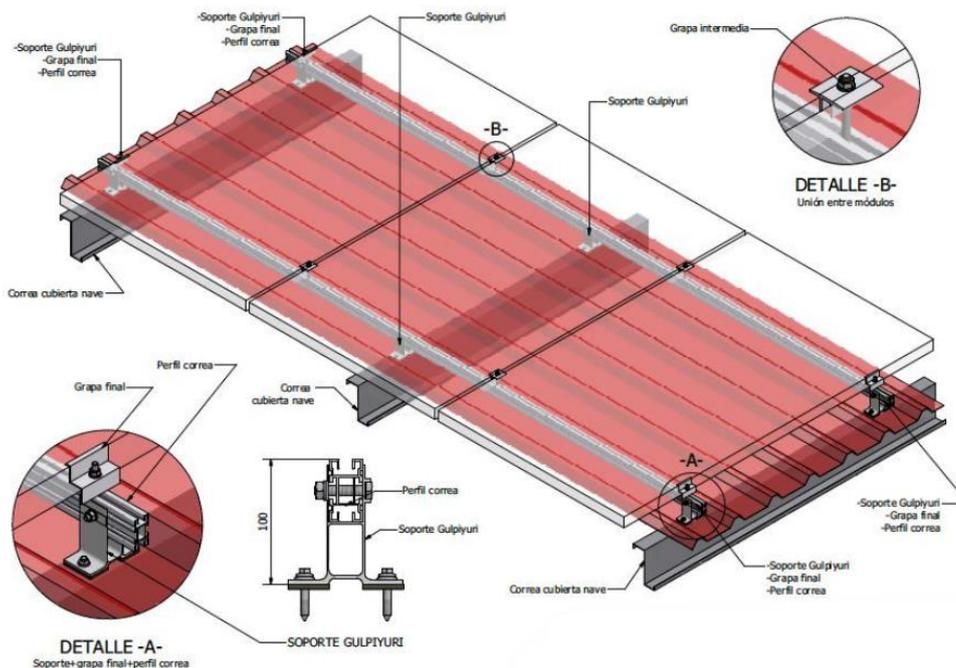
Soporte fijo de placa en cubierta inclinada [42]
